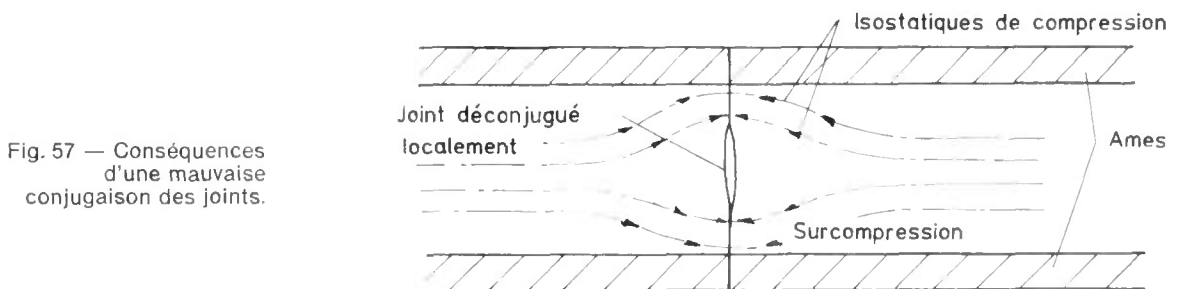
Conséquences d'une mauvaise conjugaison des joints.
